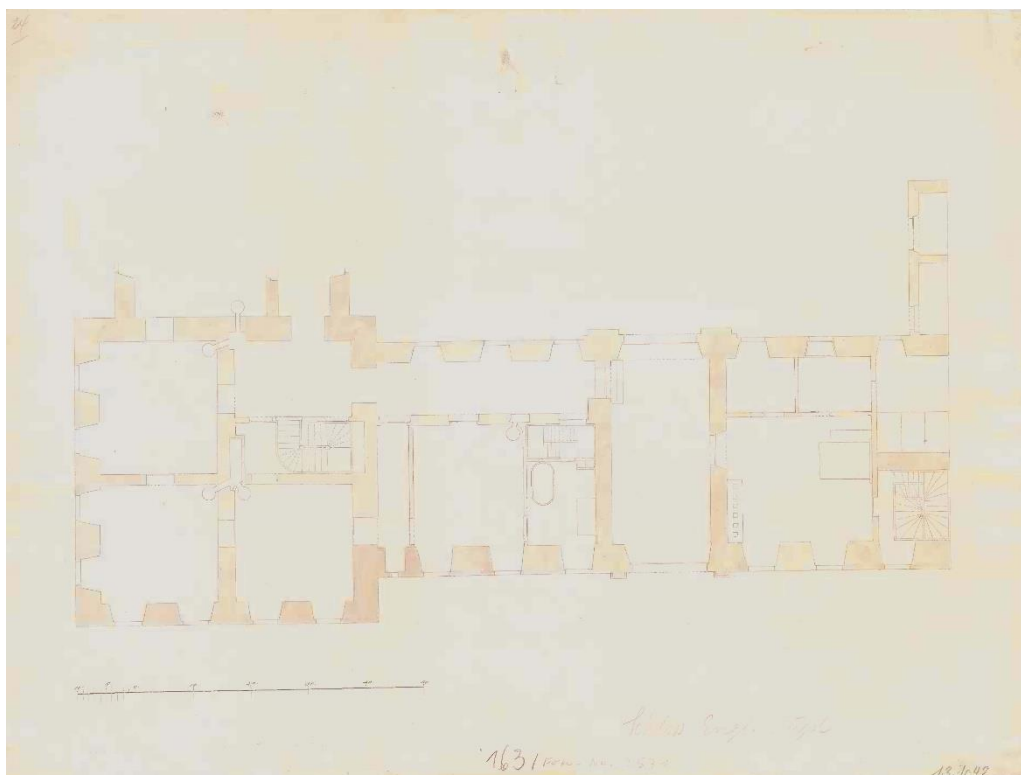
Erdgeschossgrundriss des Englischen Flügels mit Eintragungen der Umbauten. VSG, Inv.: 13.1042
